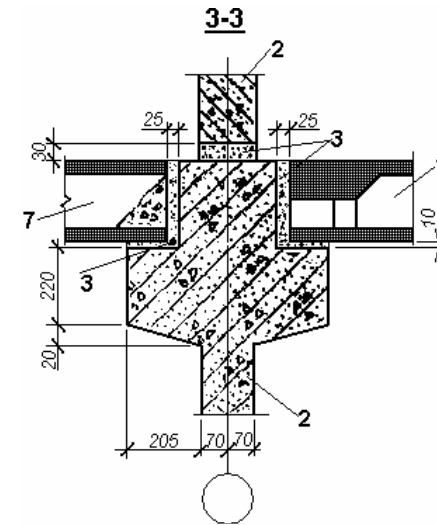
Опираие панелей перекрытия на диафрагму жесткости.
